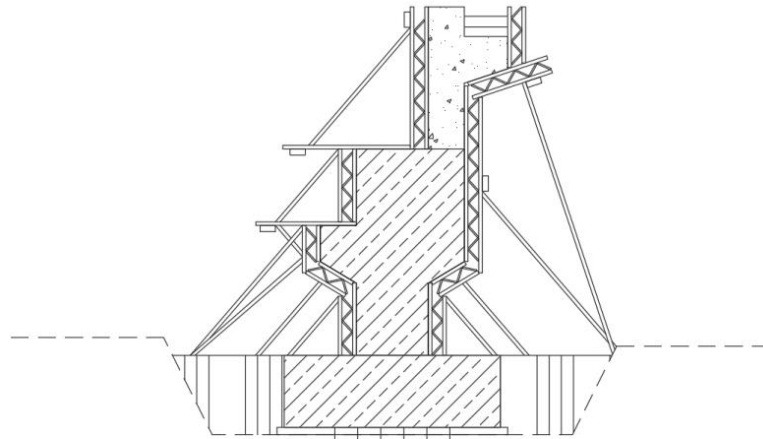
Pekerjaan bekisting badan *abutment
